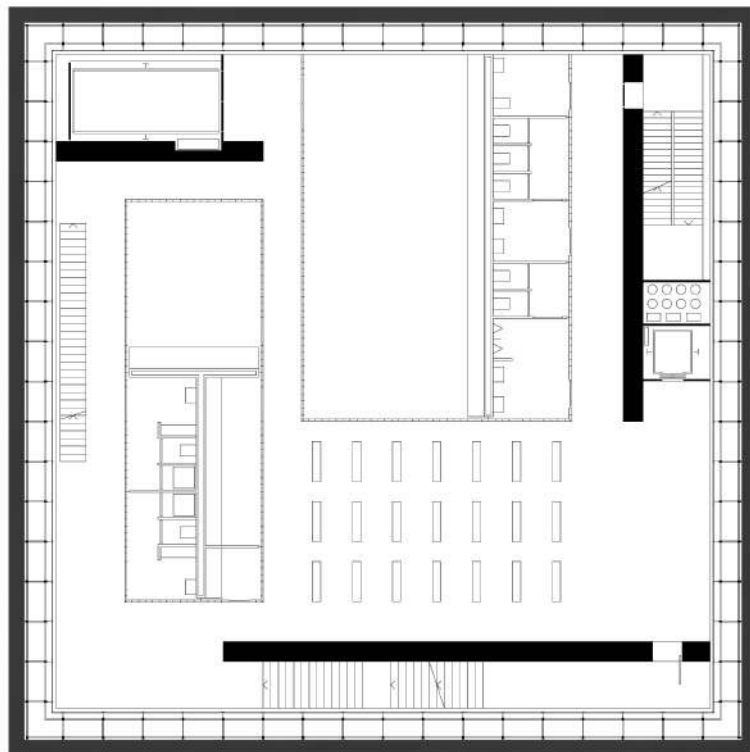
Planta piso -1 do Kunsthhaus Bregenz
